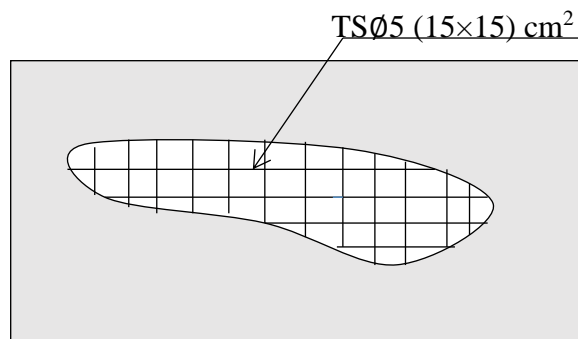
Schéma de ferraillage de la dalle de compression.
